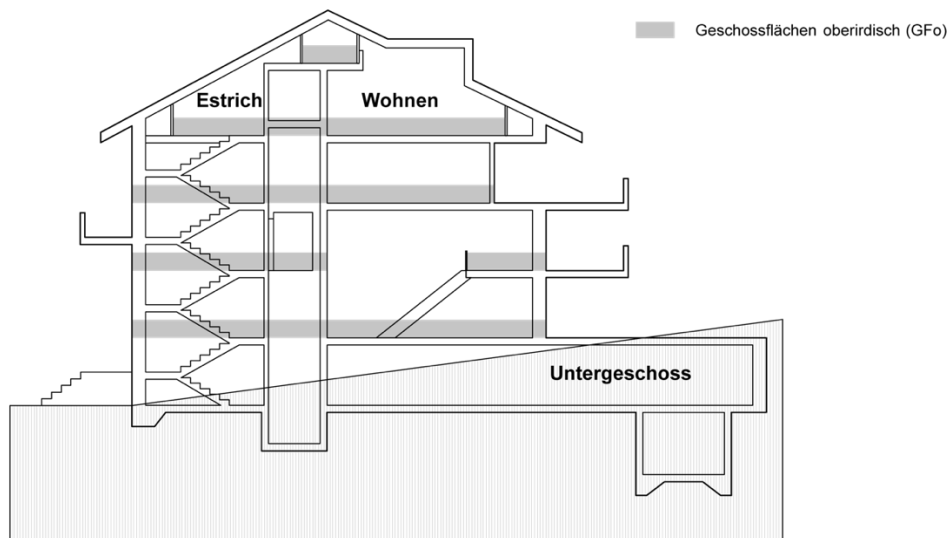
Oberirdische Geschossflächen eines Gebäudes im Schnitt
